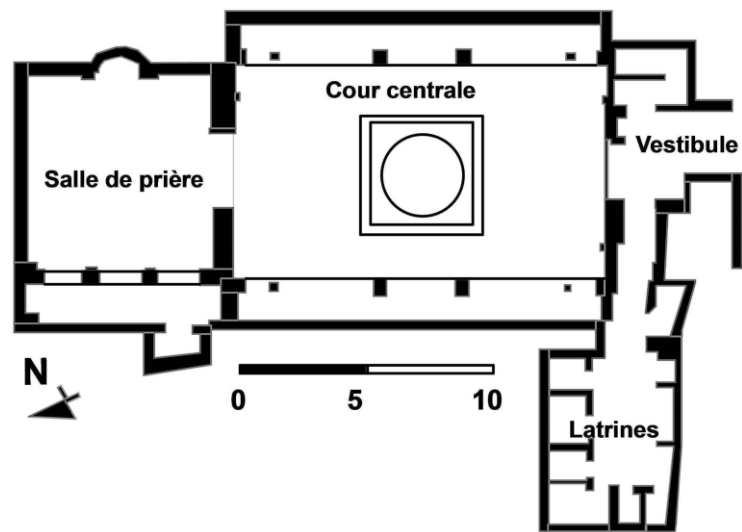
Vue en plan de rez-de-chaussée de la medersa d'el-<sup>c</sup>attârîne
